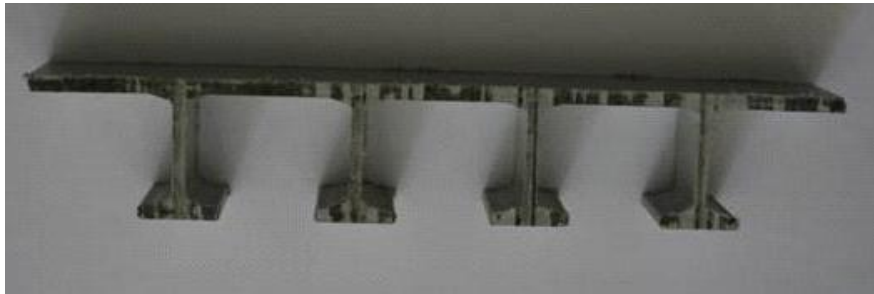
Probeta del ensayo de tracción transversal del laminado.
